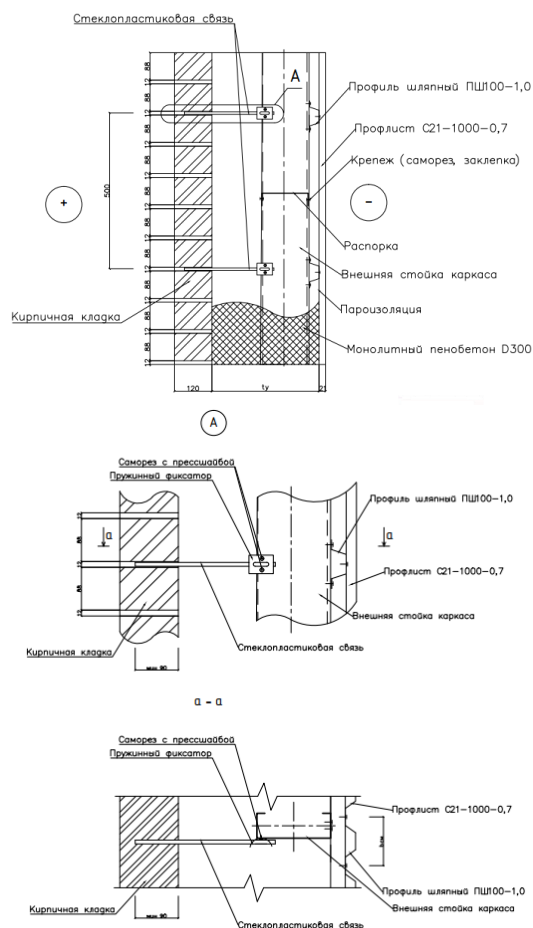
Конструкция фасадной системы из пенобетона и металлического профилированного листа применительно к стене из кирпича
